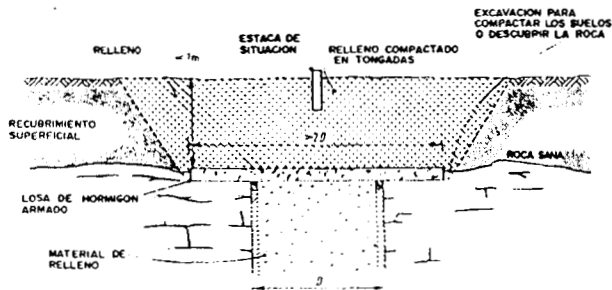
Cierre de un pozo con losa de hormigón. (Willis, A. J., 1976)
